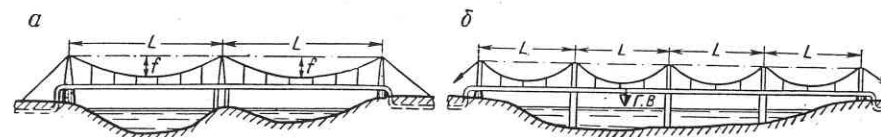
Схема многопролетных подвесных трубопроводов:
